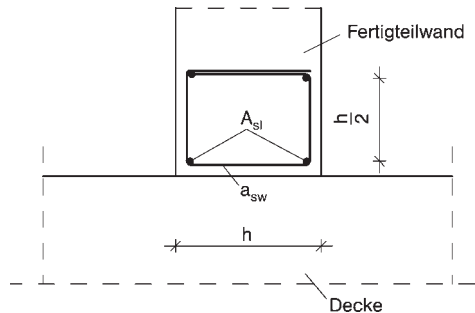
Zusätzliche Querbewehrung bei Wandstößen
